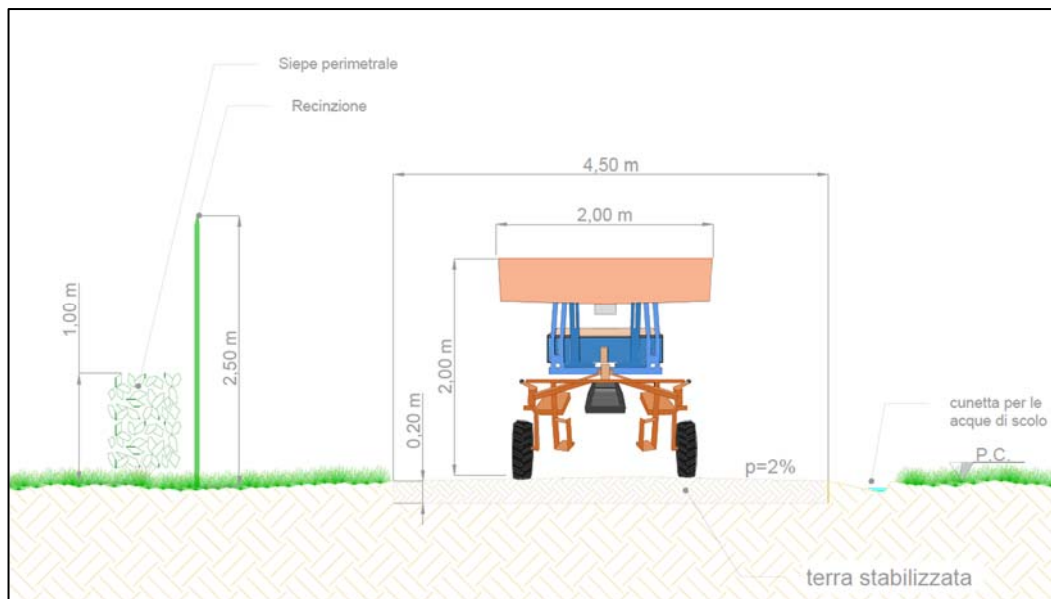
Dettaglio costruttivo delle strade per la viabilità interna al sito di installazione dell'impianto fotovoltaico
